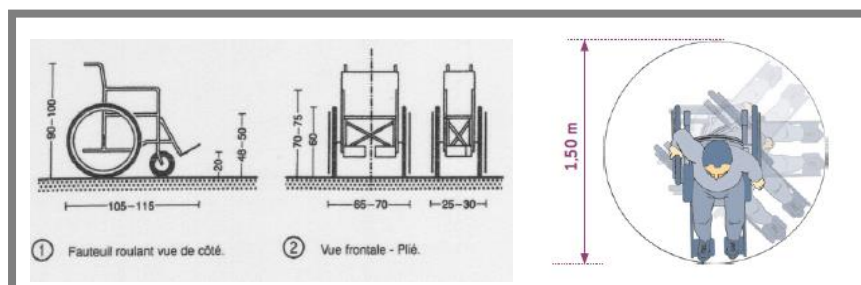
Les dimensions du fauteuil roulant pour handicapés
